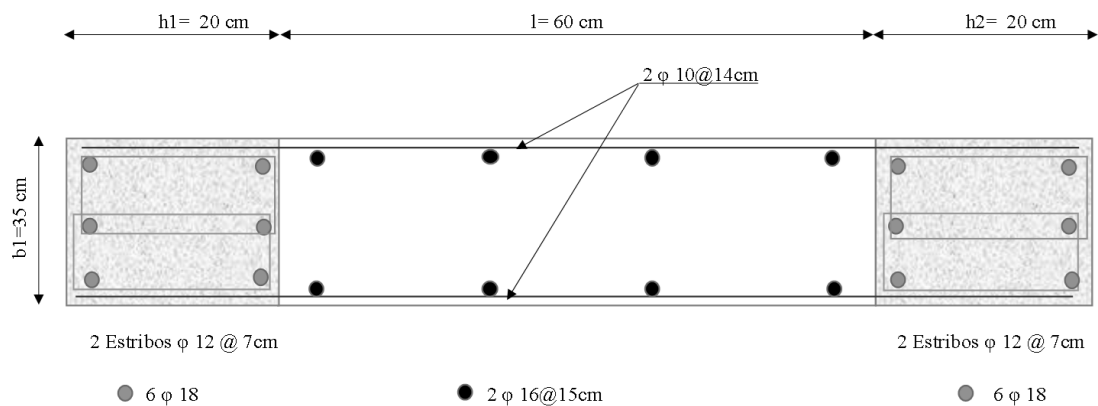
Armado del muro correspondiente a la geometría 3 en base al DDBD
